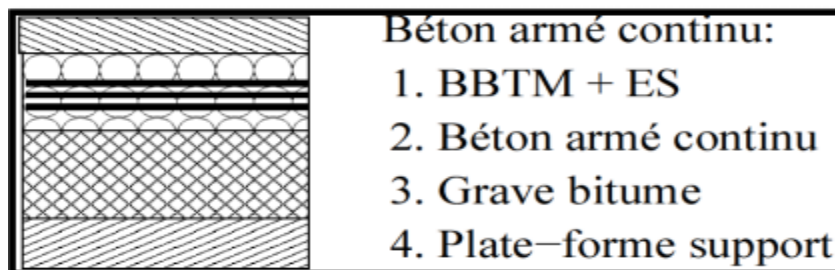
Chaussée en béton armé continu sur grave bitume (BAC/GB) [10]
